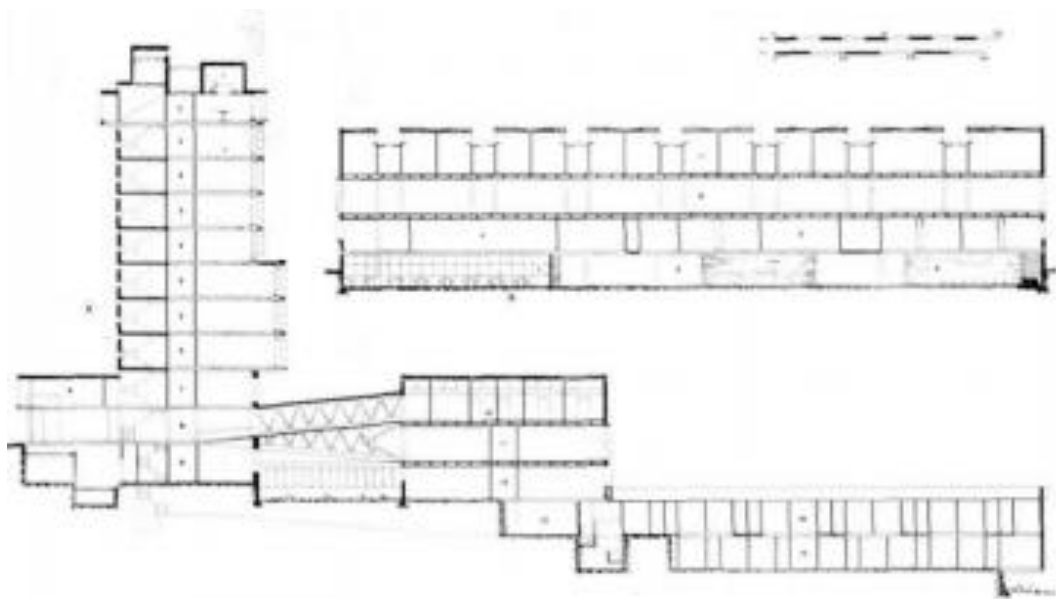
Corte longitudinal e transversal do Instituto Central do Câncer
